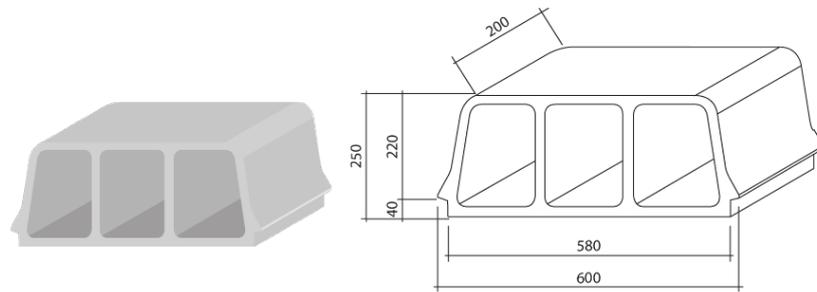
Bovedilla de hormigón prefabricado. ORIGEN: www.ibanezejido.com
